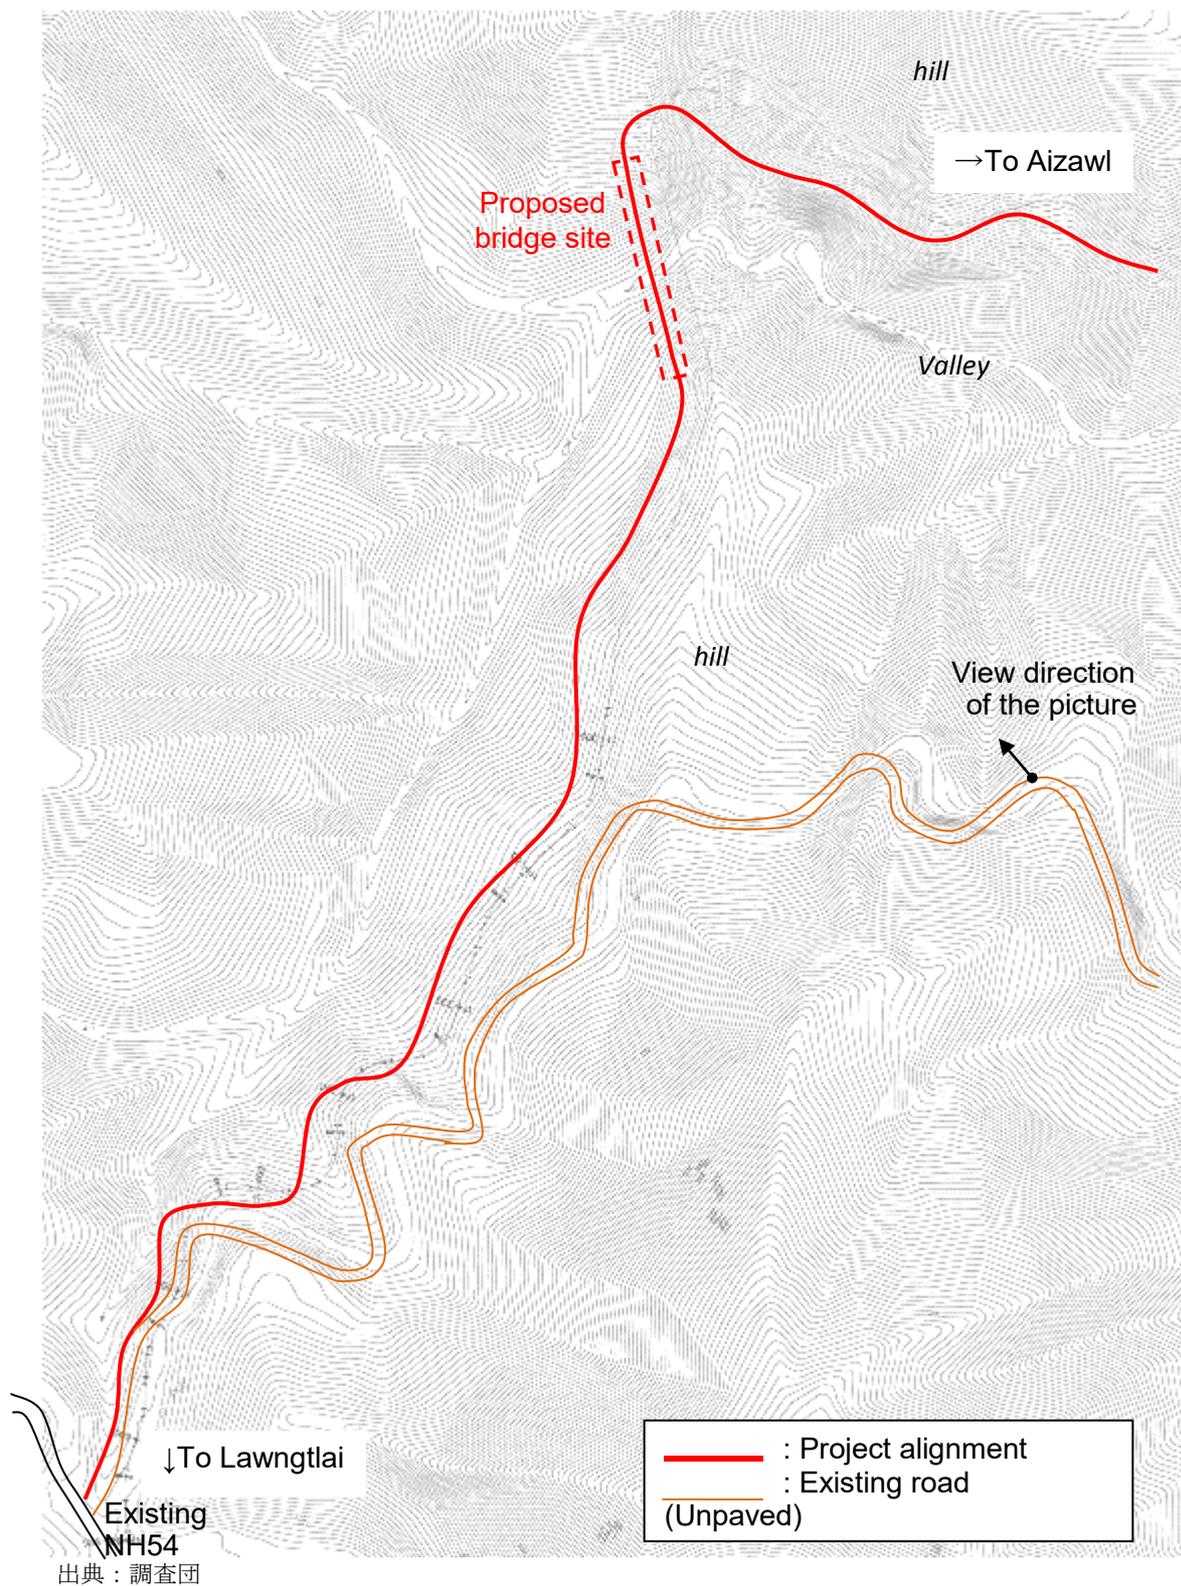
Serchhip bypass Major Bridge の計画位置図
